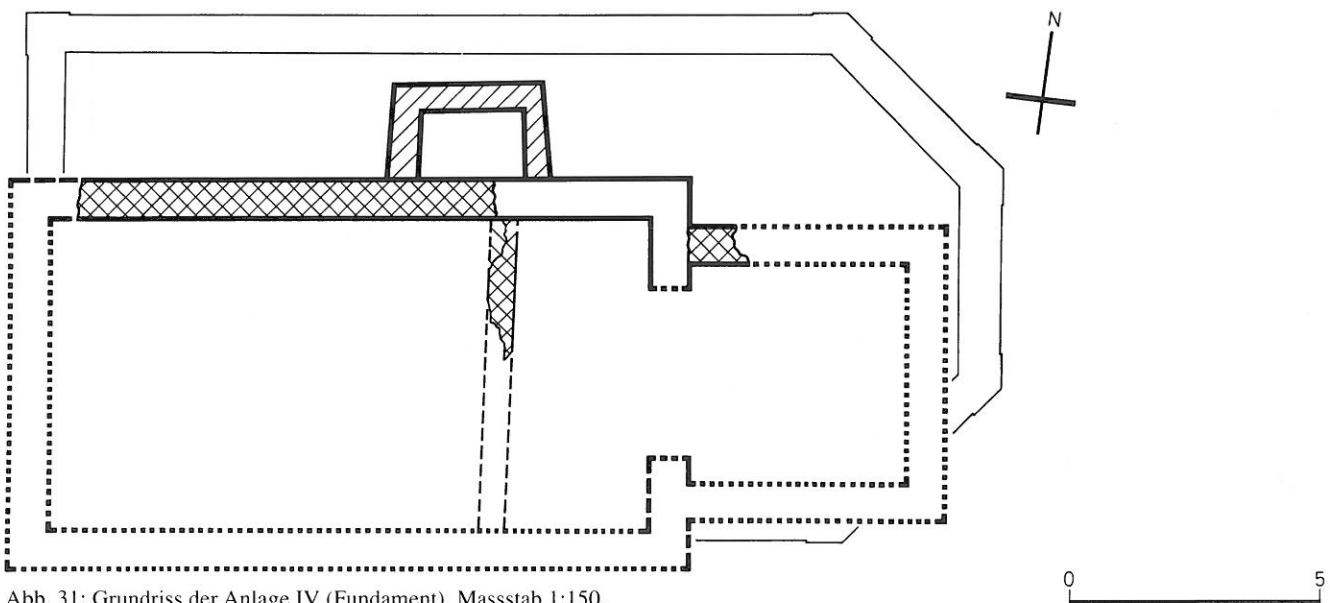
Grundriss der Anlage IV (Fundament). Massstab 1:150.
